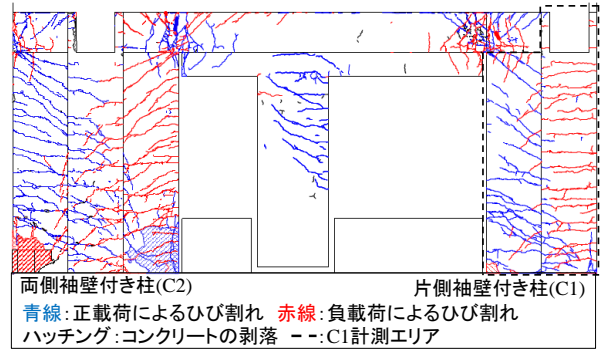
ひび割れ図 ($R_r=1/50rad$)
